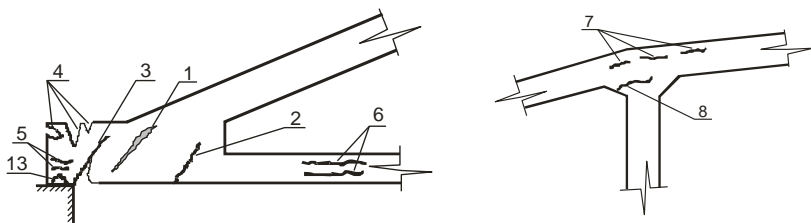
Картина трещинообразования в стропильной ферме:
